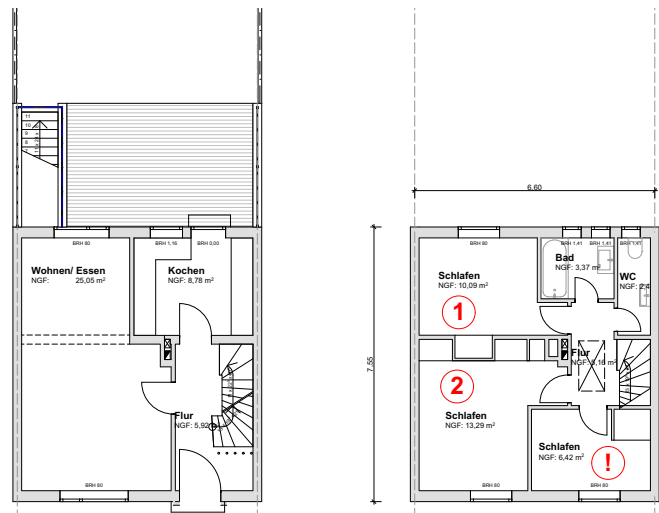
Grundriss Bestand Typ C4 RH
